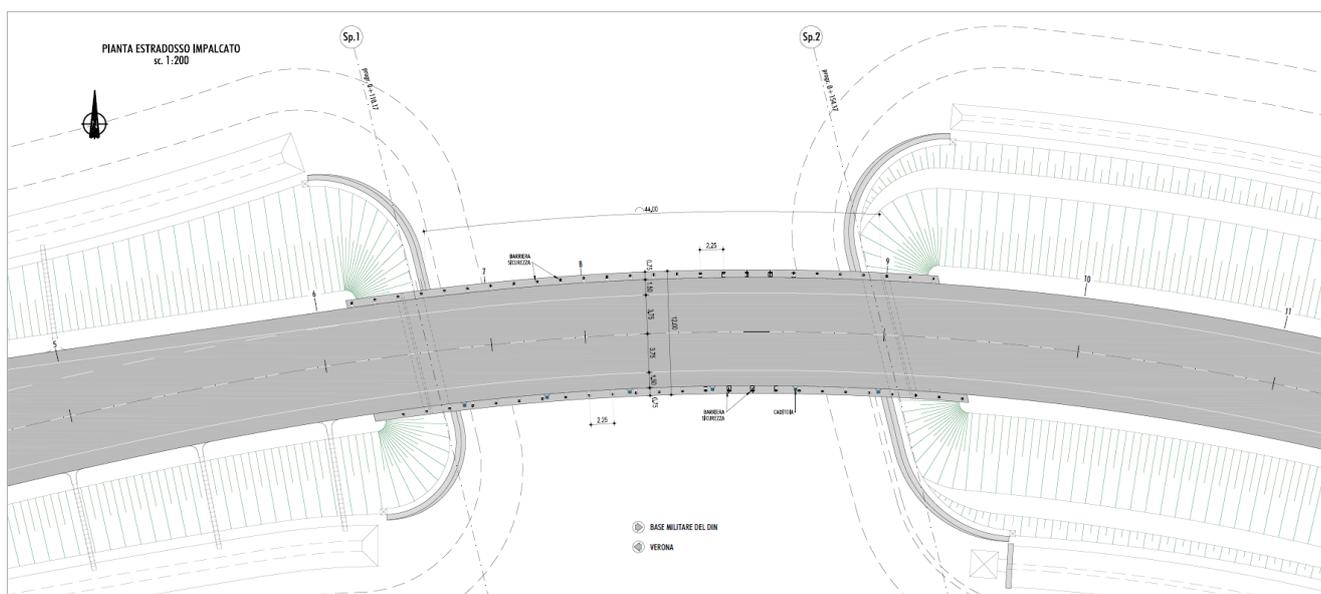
VISTA IN PIANTA DEL PONTE – LIVELLO IMPALCATO
